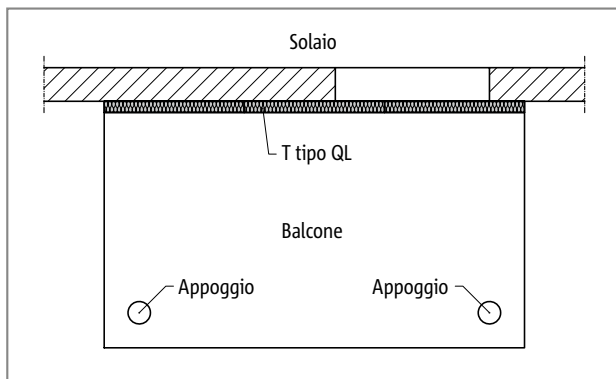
Schöck Isokorb® T tipo QL: balcone appoggiato su pilastri
